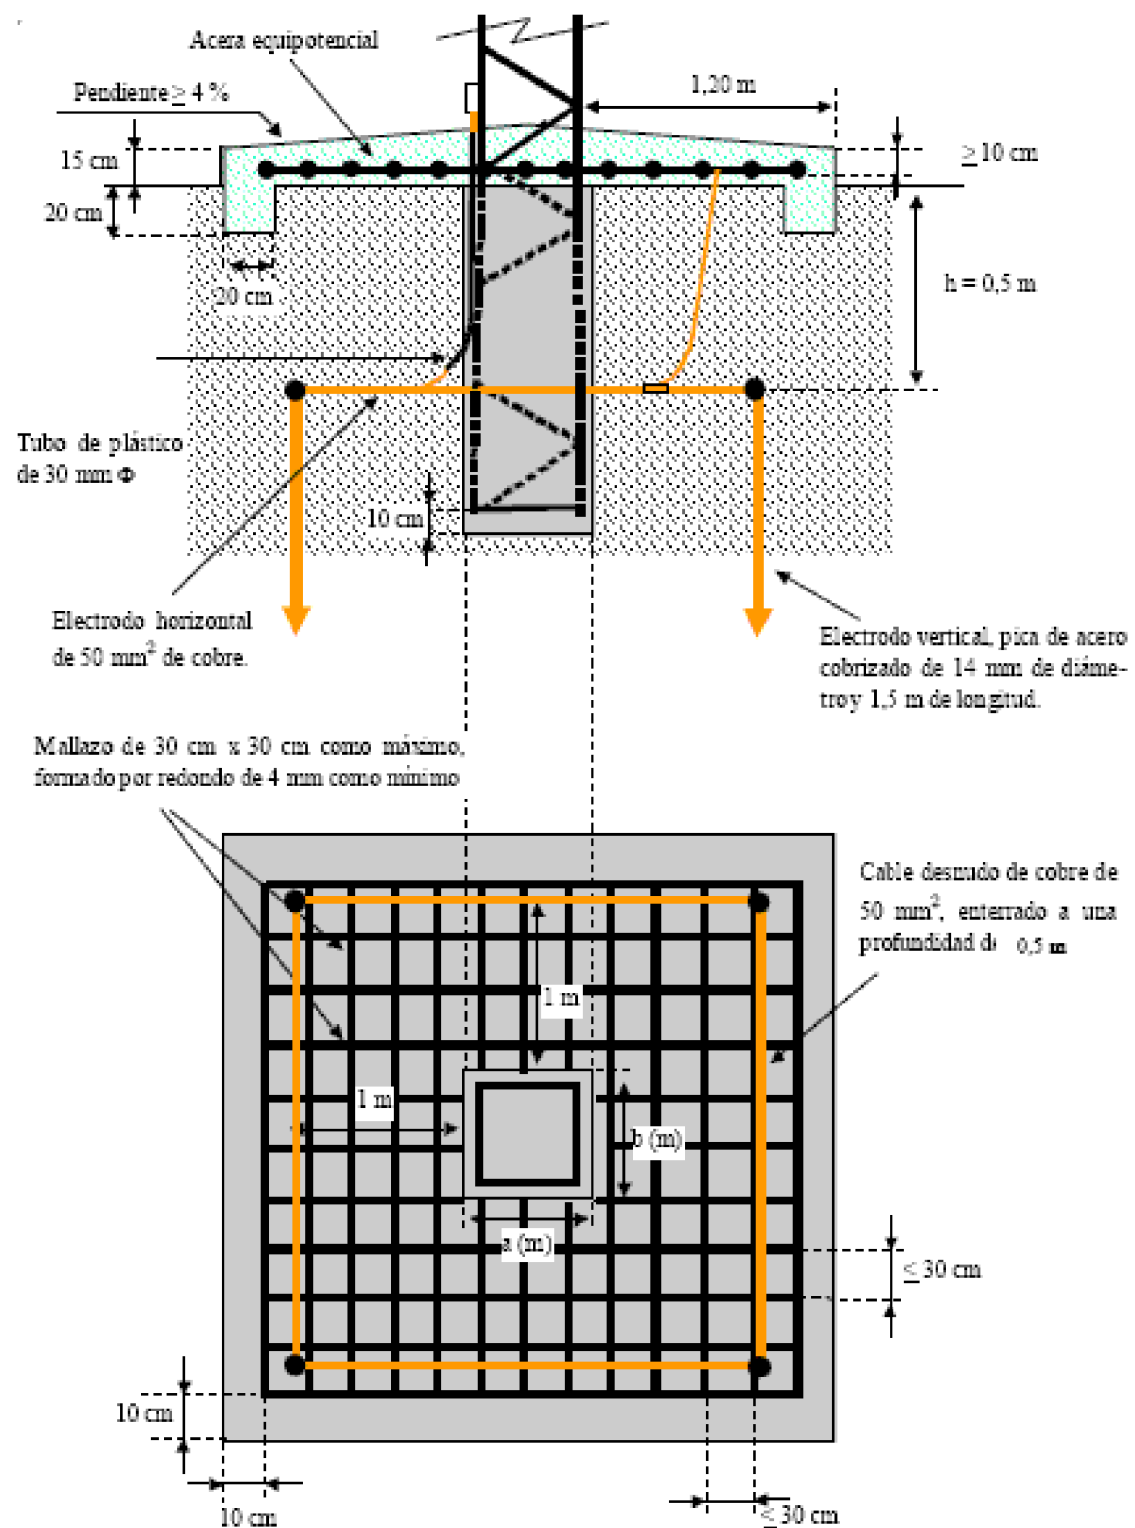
Acera de hormigón, con mallazo equipotencial, perimetral con la cimentación del apoyo, empleado en líneas aéreas con apoyos frecuentados con calzado.
